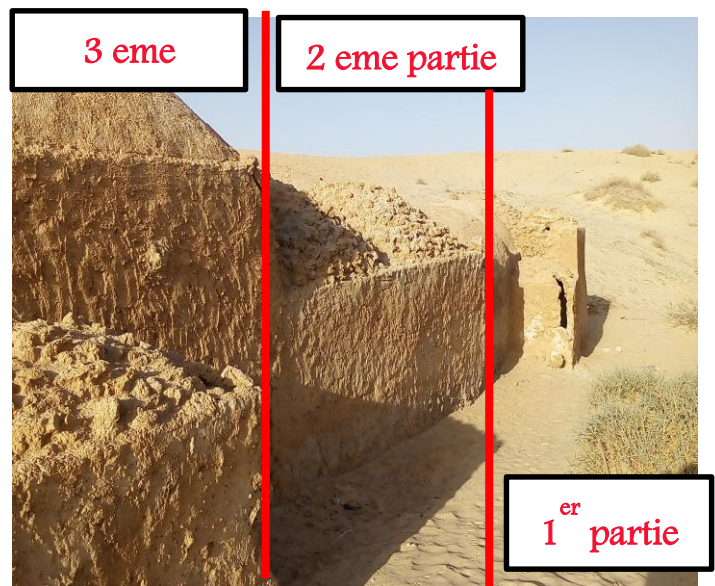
l'évolution de la construction au niveau Du plan de RDC
